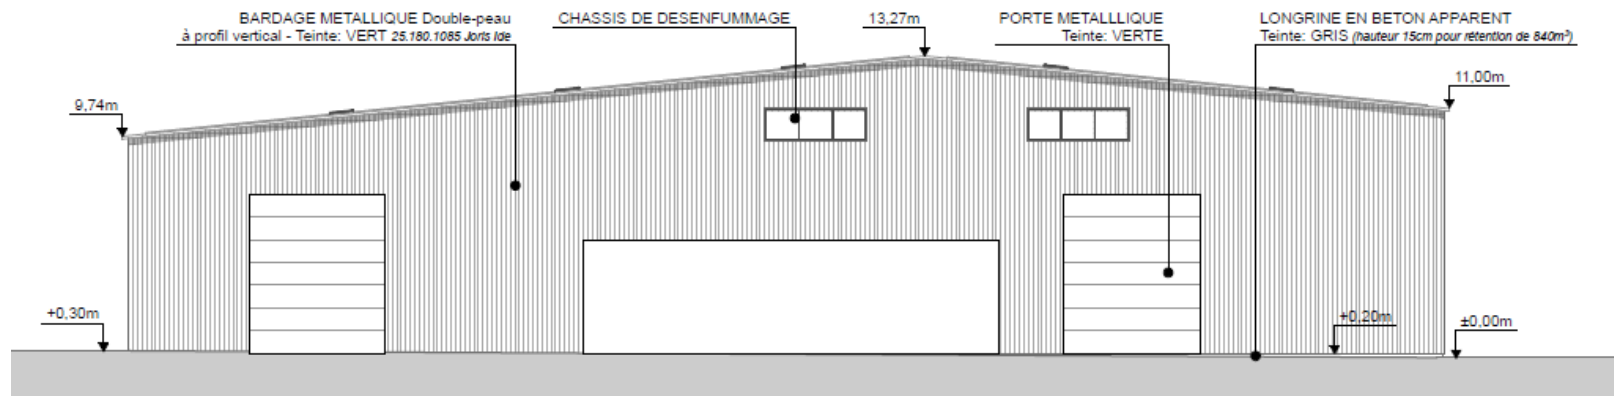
BATIMENT PROJETE – FAÇADE EST – INSERTION SUR LE SITE EXISTANT
